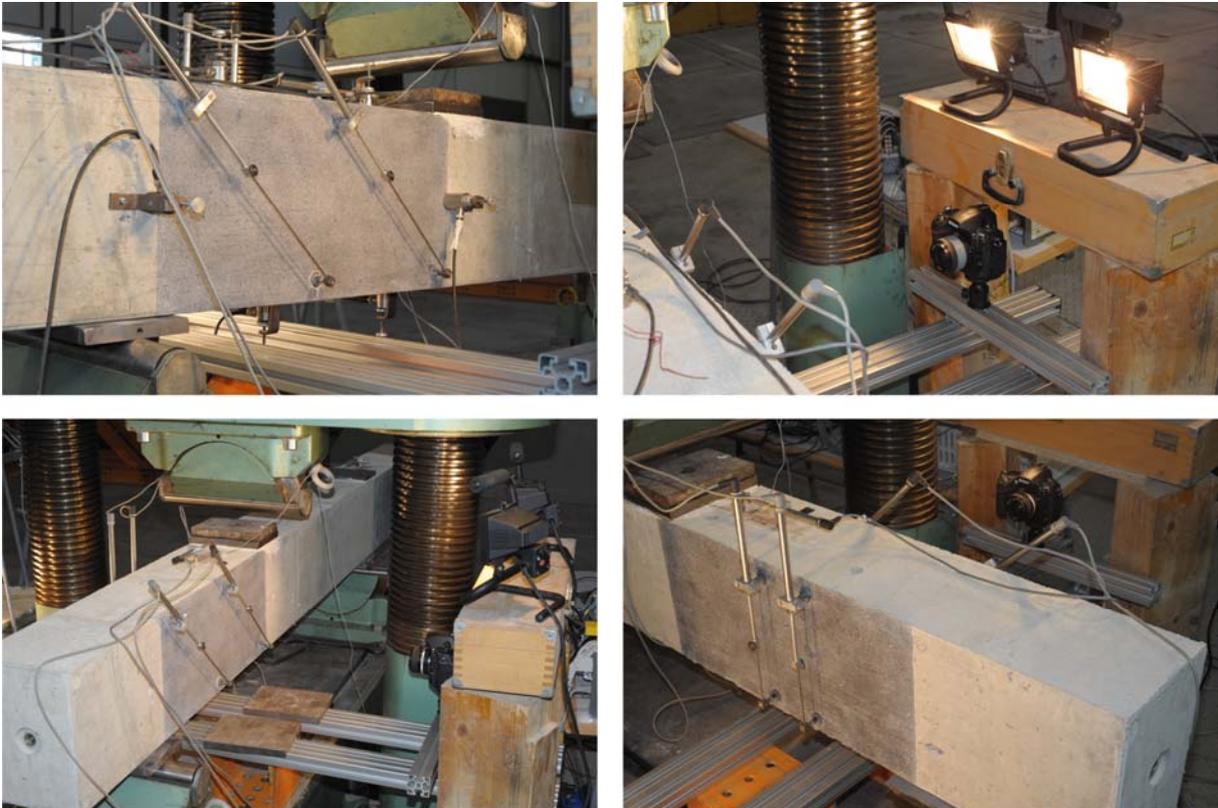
Darstellung der applizierten Messtechniken an den Stahlbetonversuchskörpern ohne Bügelbewehrung
